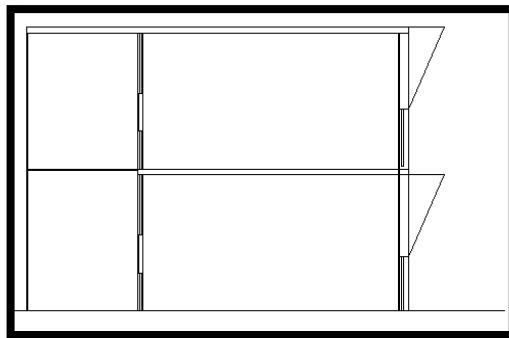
schéma sur les brises soleil de la façade sud, AUTEURS
